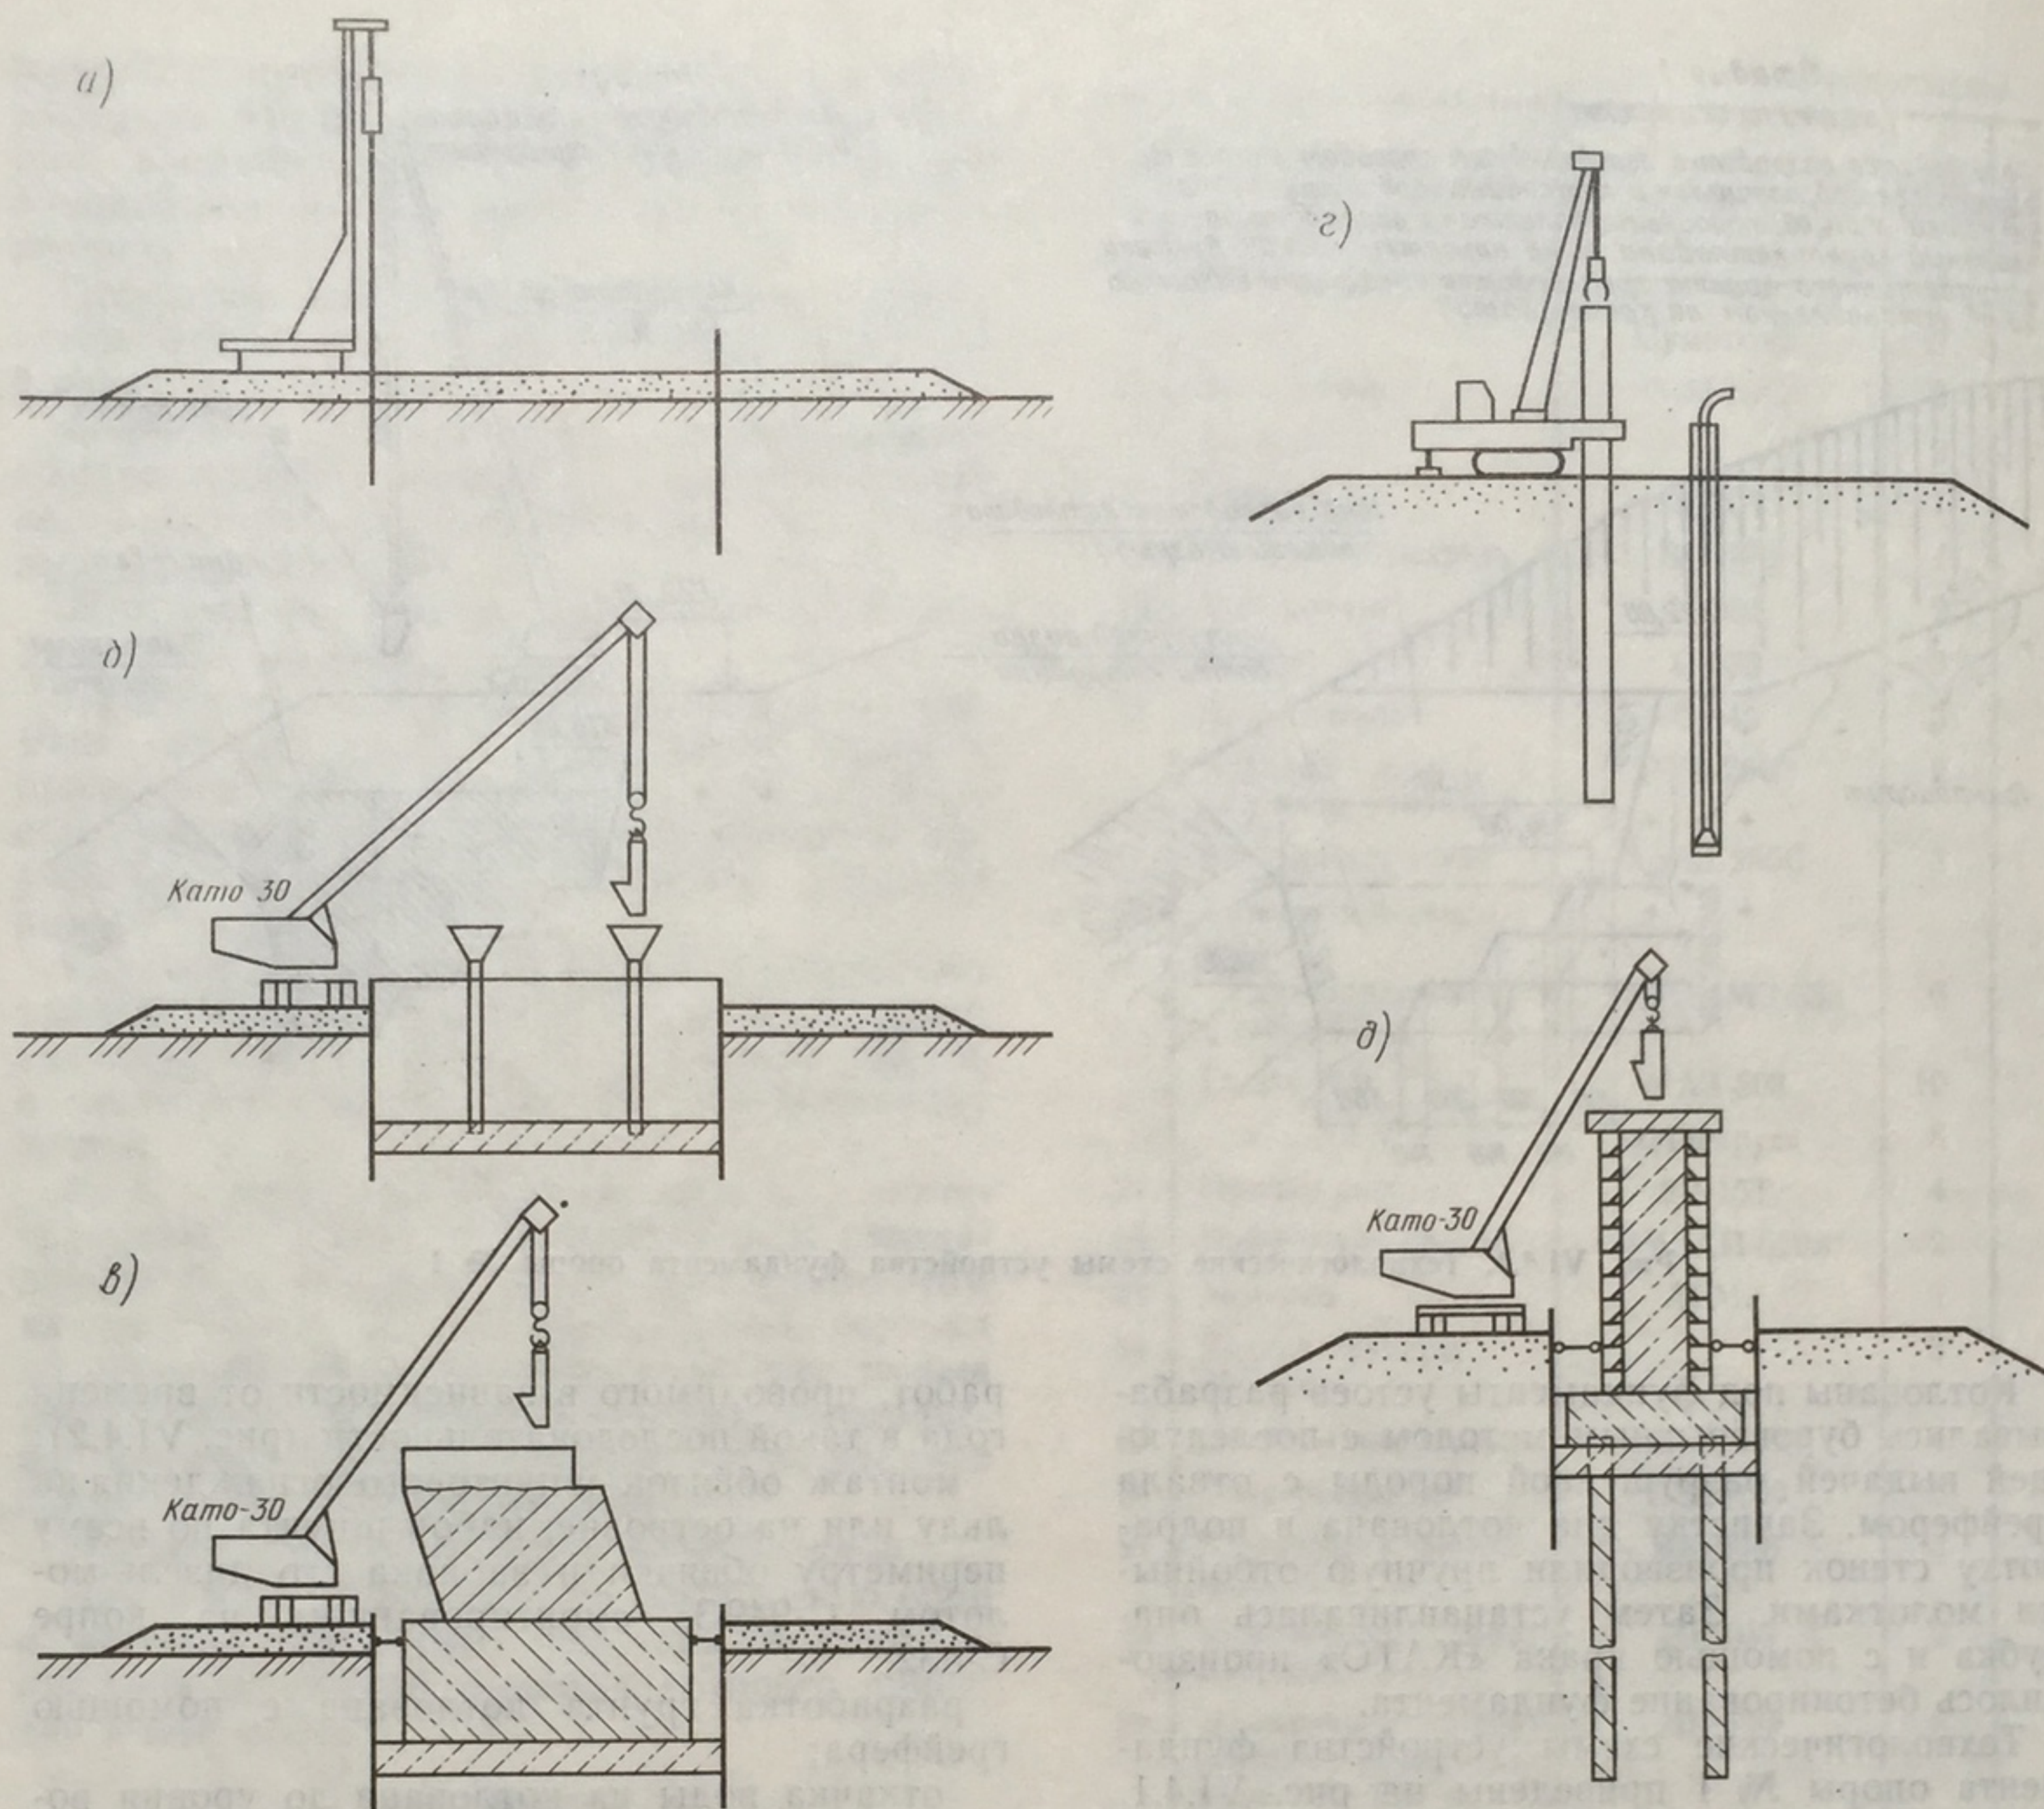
Цикл работ по сооружению фундаментов опор:
